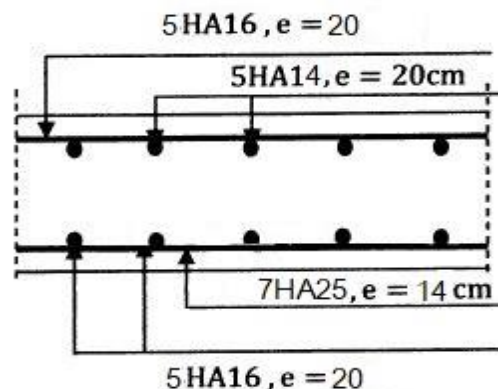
5 : Schéma ferraillage transversale de la dalle de transition
